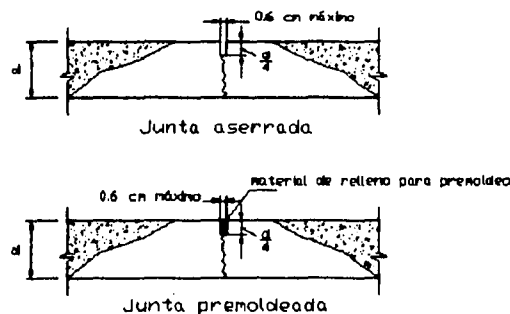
Agrietamiento de la losa posterior al aserrado
